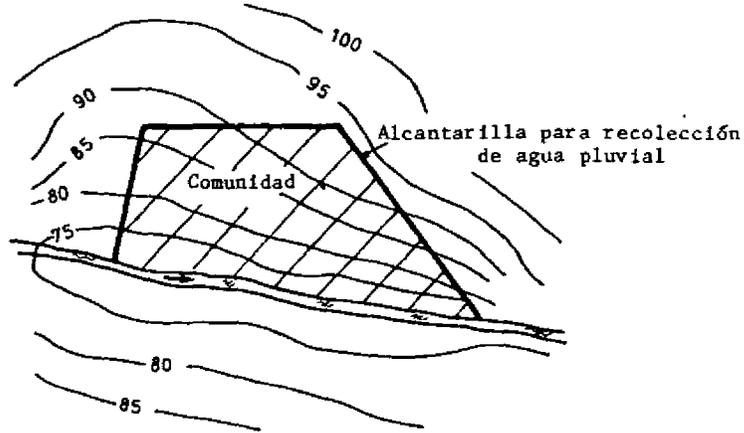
10: Alcantarilla para agua pluvial proveniente de zonas distantes
